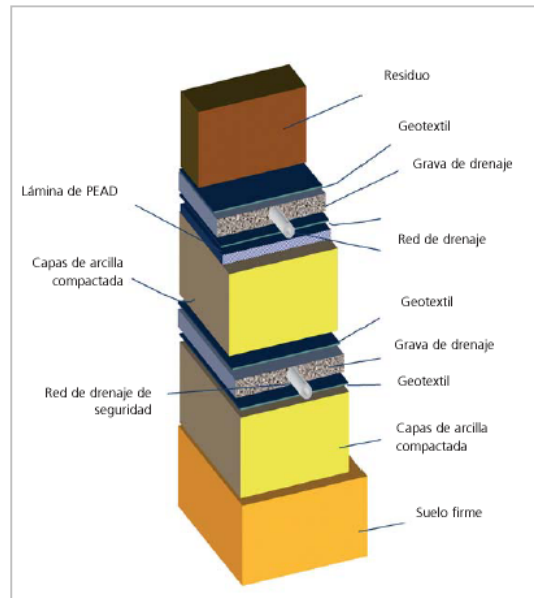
Corte transversal de la impermeabilización y red de drenaje.
